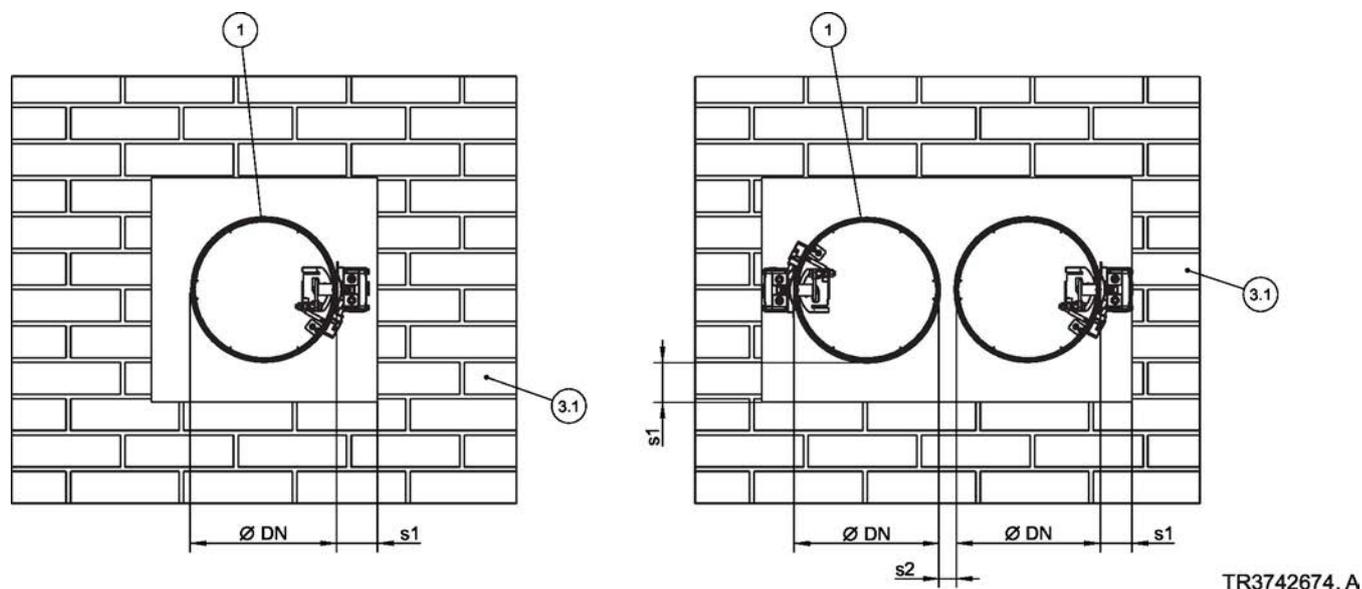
Pareti piene – disposizione/distanze, la disposizione fianco a fianco si applica anche alla disposizione una sotto l'altra
